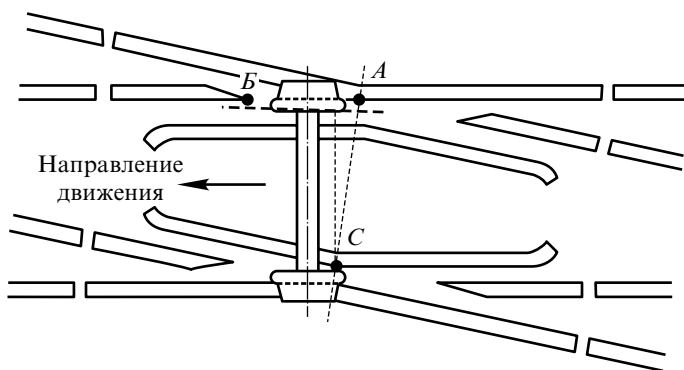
Схема прохода колесной пары через глухое косоугольное пересечение
